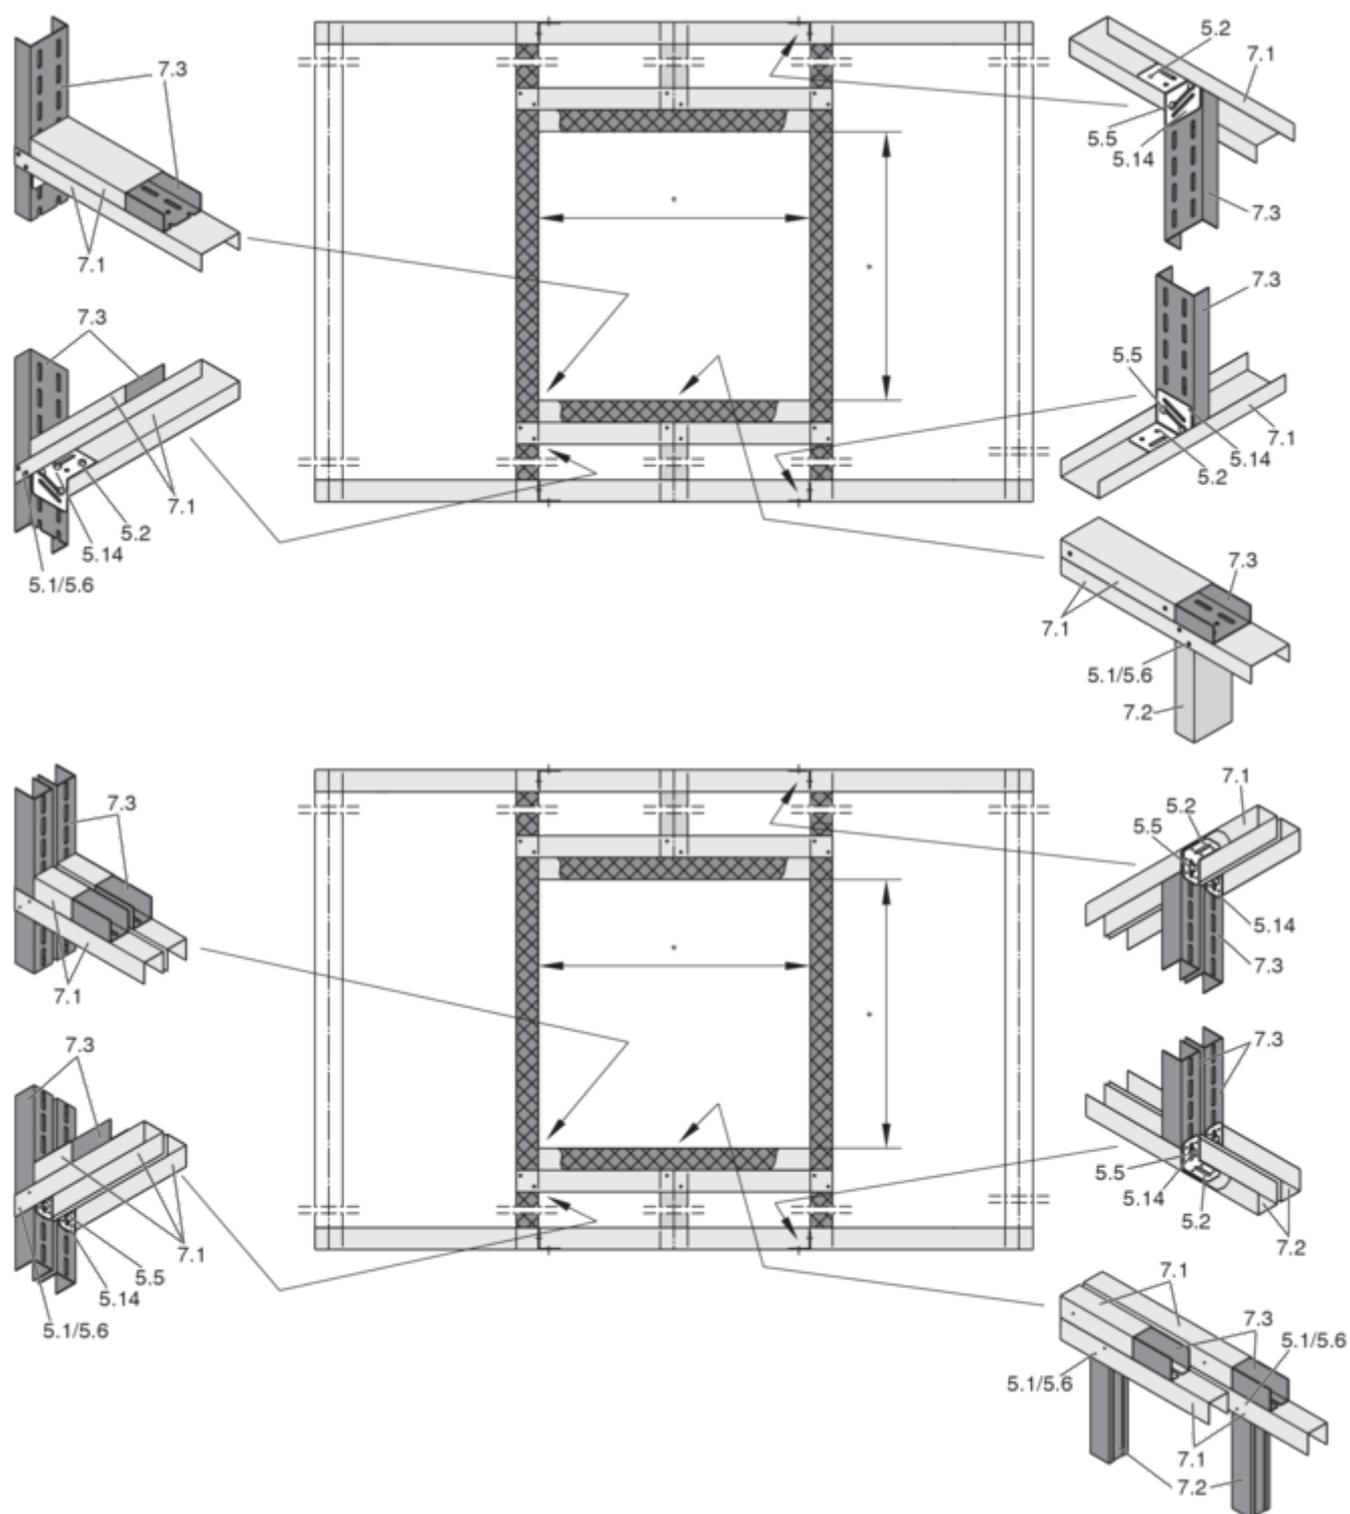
Estrutura de apoio de metal para uma parede de compartimento, sistema de cavilha simples e sistema de cavilha dupla
